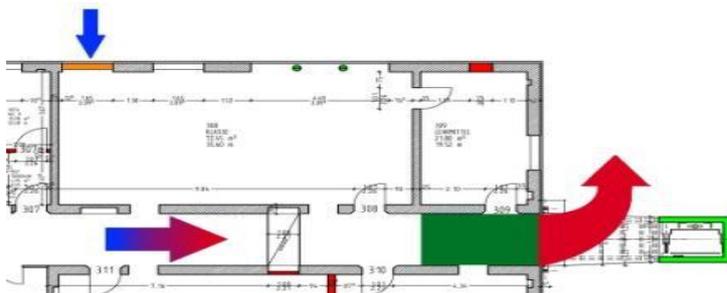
Geschoßlüftung mit Nachrüstung von Klappfenstereinsätzen als Nachströmöffnungen für kühle Frischluft
